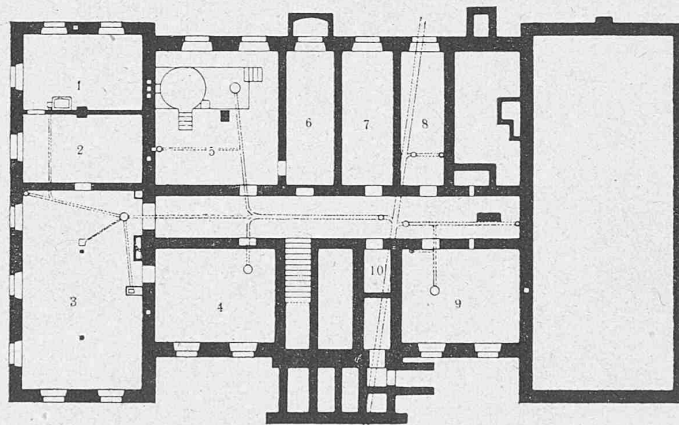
Grundriss vom Kellergeschos, — Masstab 1 : 200.
